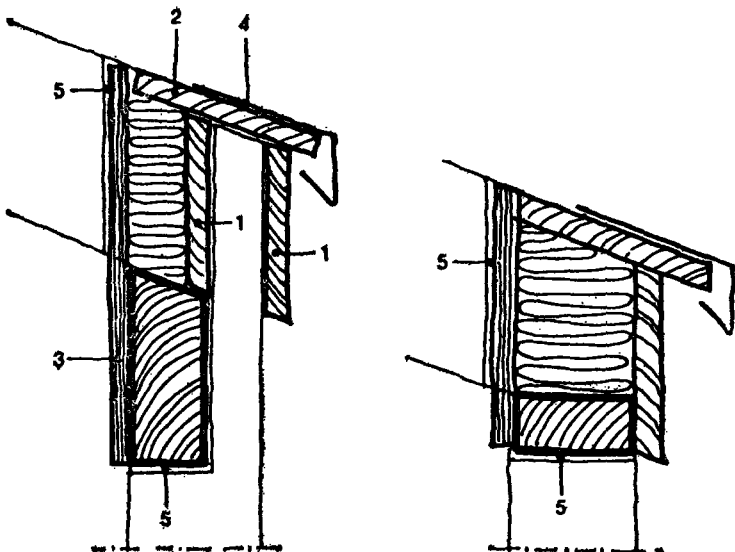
Карниз крыши (покрытие, теплоизоляция и гидроизоляция)
